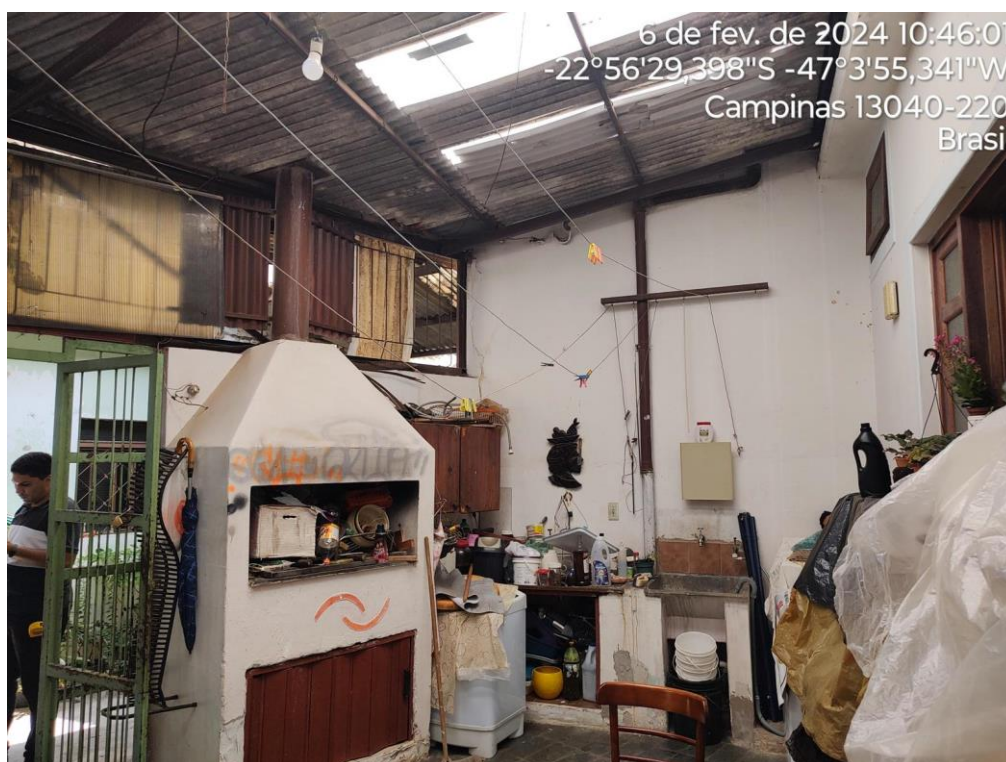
CASA III – ÁREA DE SERVIÇO
